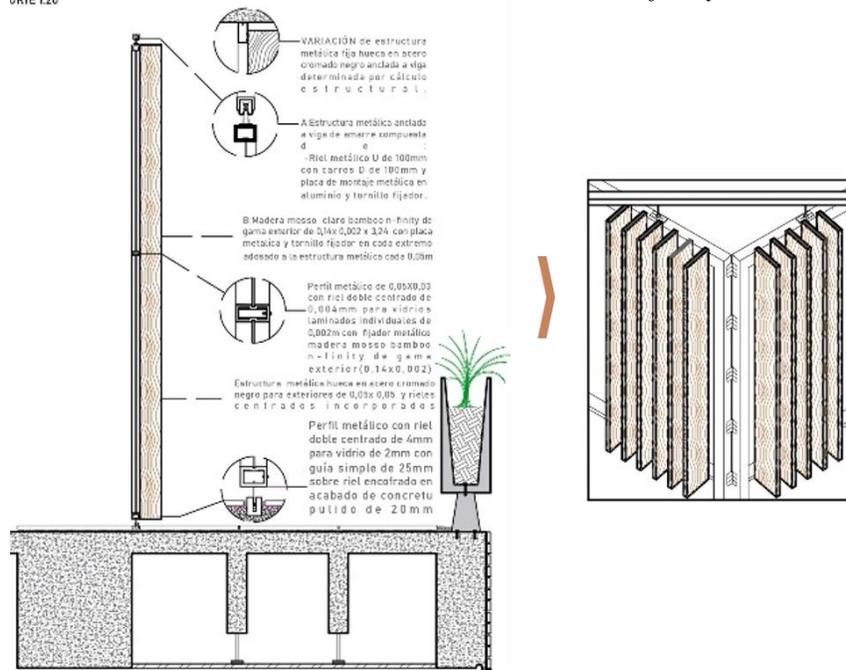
Detalle de muro seriado en madera Mosso bamboo n-finity.
